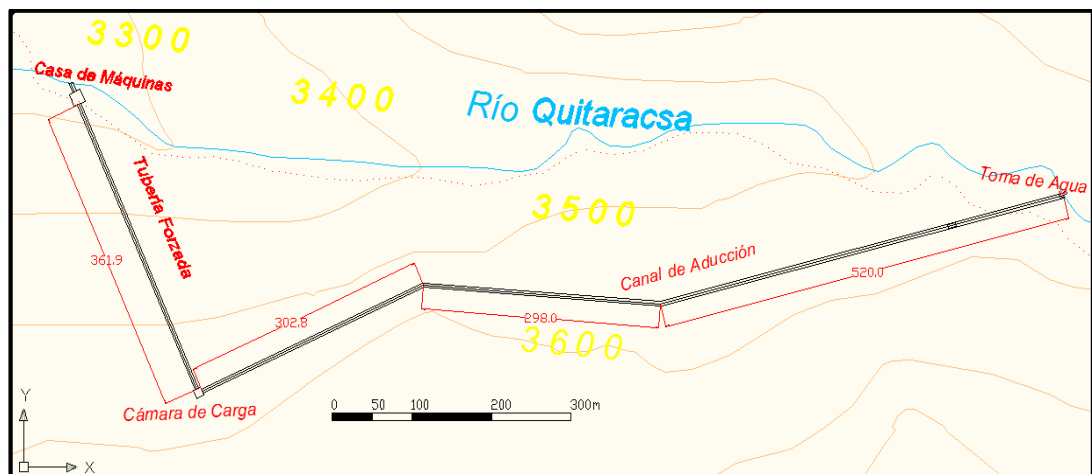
Layout de las instalaciones principales para la minicentral, todas las cotas están medidas en la vista de planta
